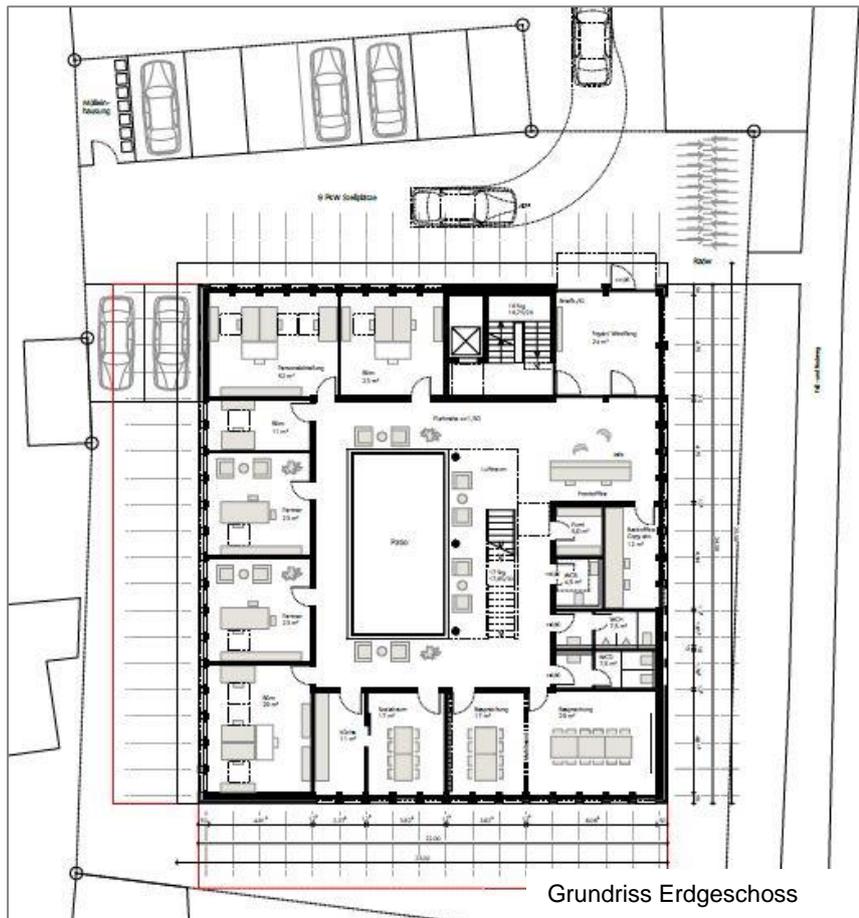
Grundrisse zum Gebäudeentwurf vom 20.04.2020
